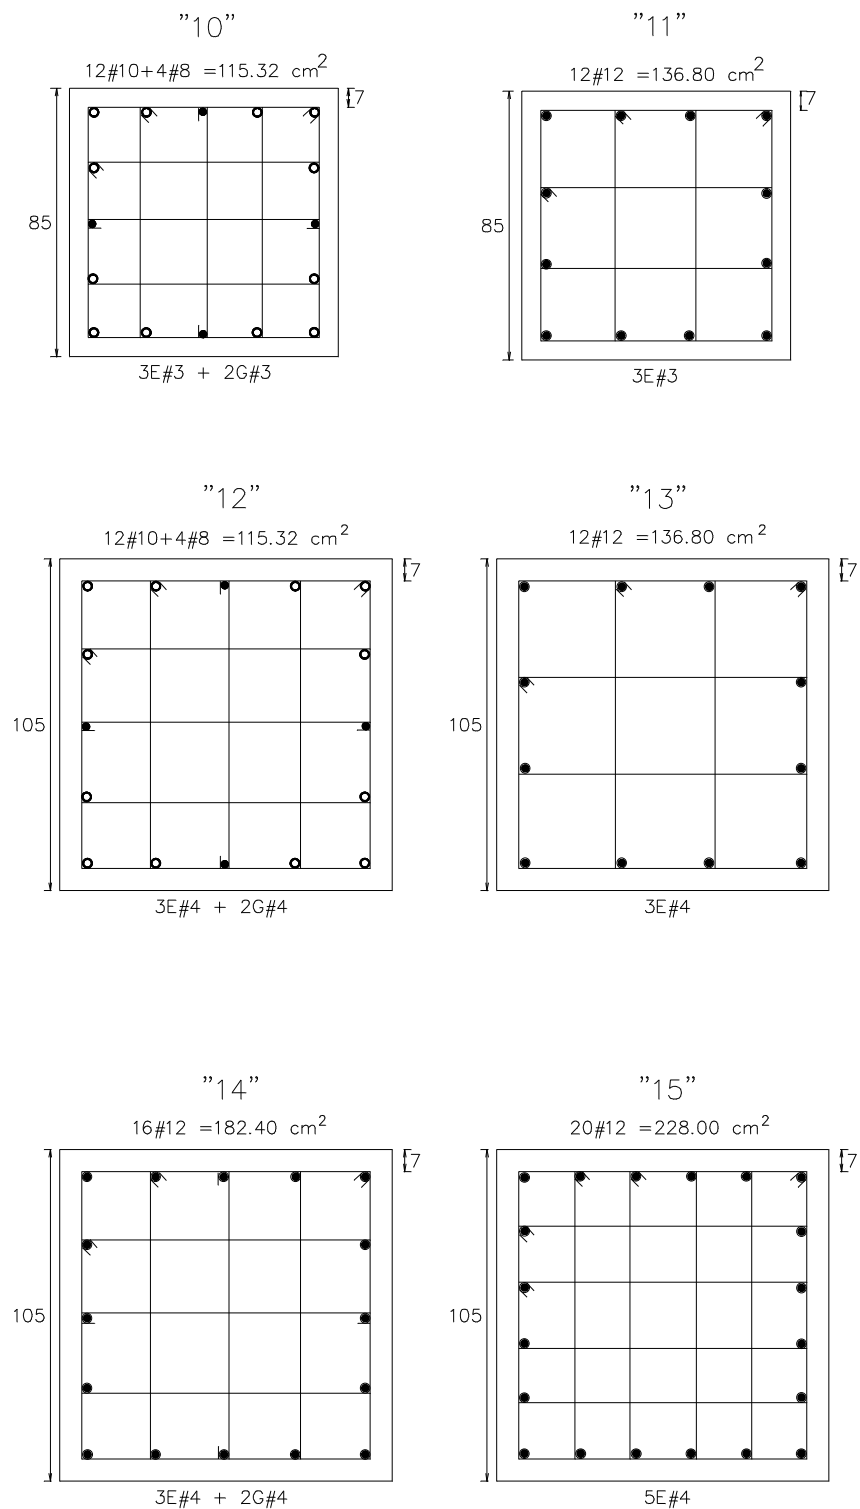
Tipos de armados propuestos para las columnas del eje 2, estructuras de 17 niveles diseñadas en zona III (RDF-93 y RDF-04)
